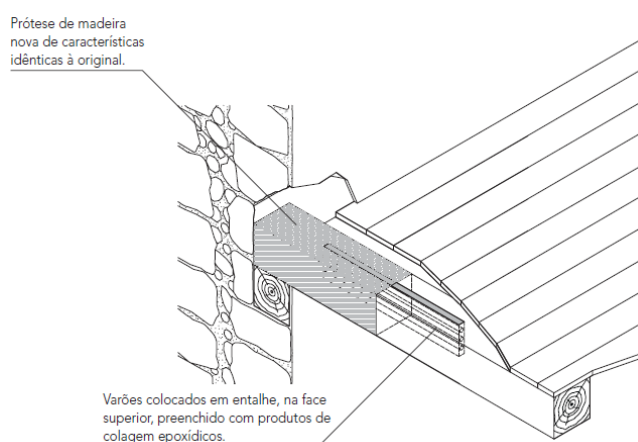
Esquema de vigamento de pavimento [Jiménez Díaz, 2001].
